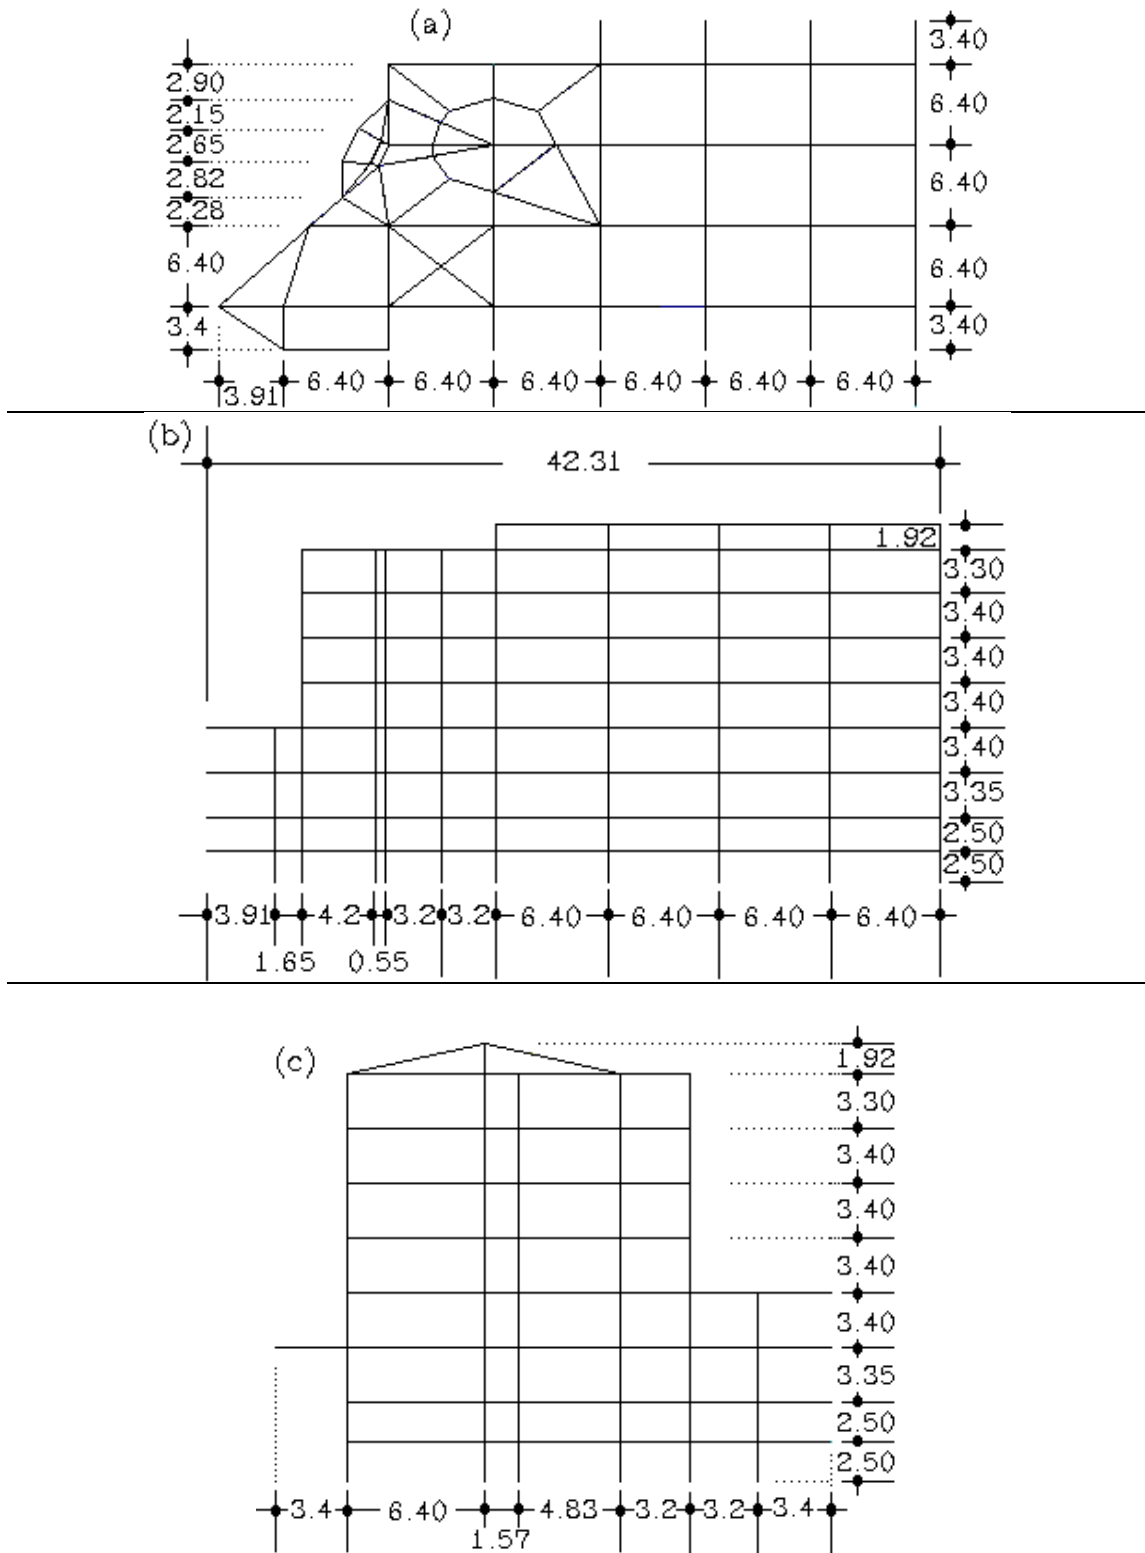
Esquema de la sección estudiada del edificio FU. a) Vista en planta; b) Alzado longitudinal; c) Alzado transversal. Todas las dimensiones se dan en metros.
